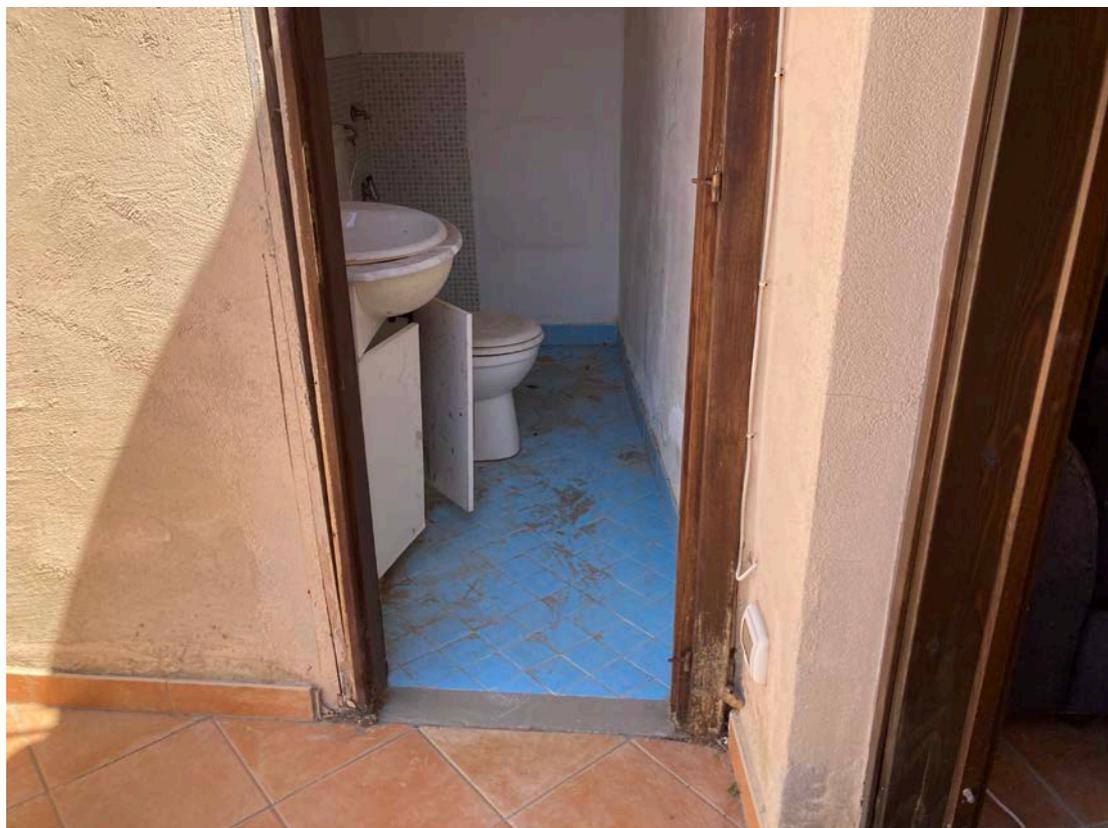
veduta del locale wc abusivo al Piano 1°
